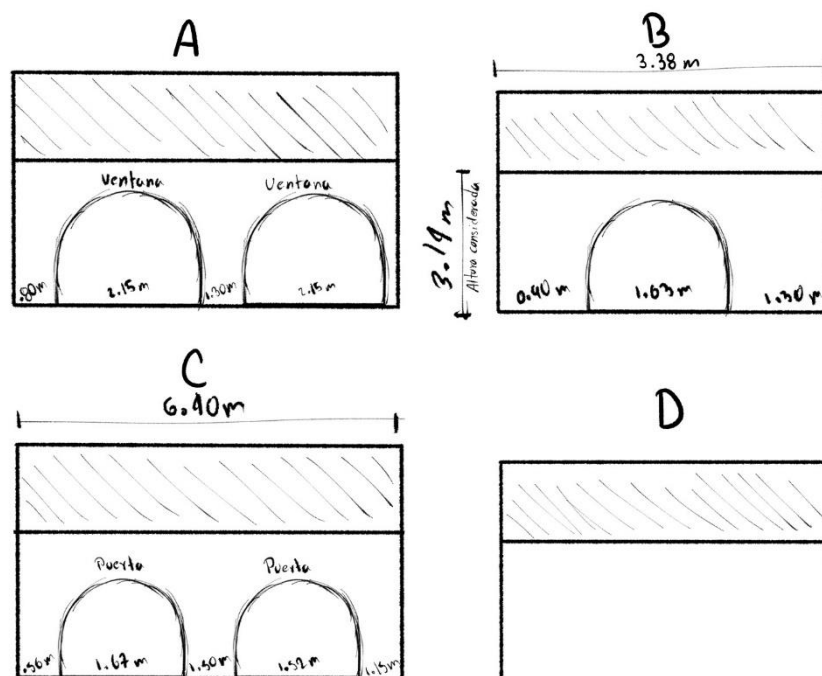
Vista individual de los muros de la sala de lectura. Muro A: con vista al área de cafetería. Muro B: con conexión al pasillo de baños y a otra sala de la librería. Muro C: con vista a la entrada. Muro D: pared completa frente al muro B.
